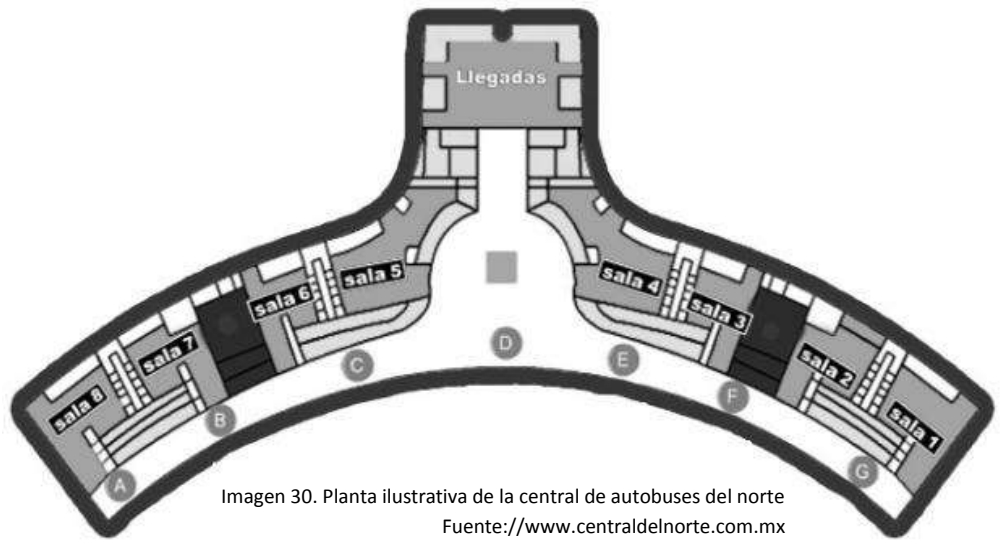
Planta ilustrativa de la central de autobuses del norte
